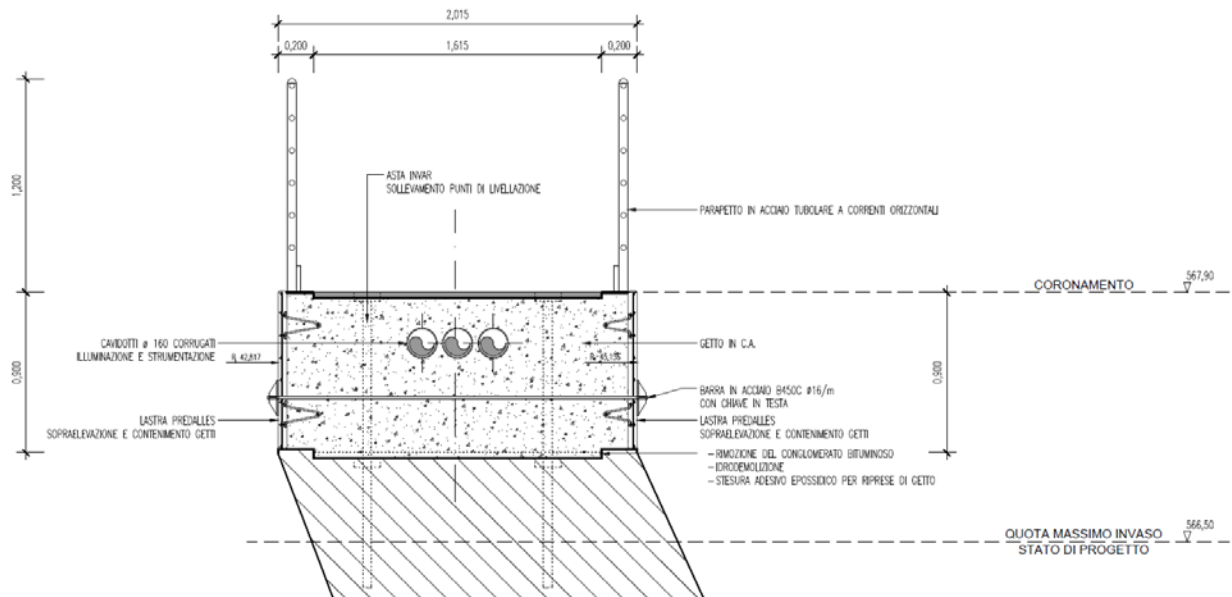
Sezione tipo del sovrizzo della diga nella sezione corrente.
